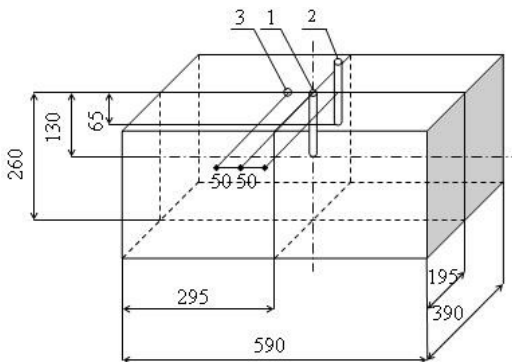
Схема расположения термопар в образце: 1-3 – номера термопар
